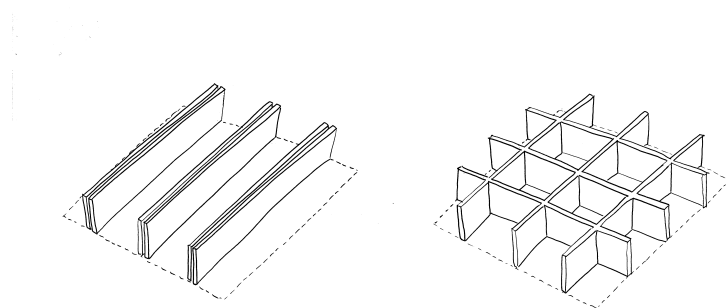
Desdoblando vigas ... para obtener emparrillados.
